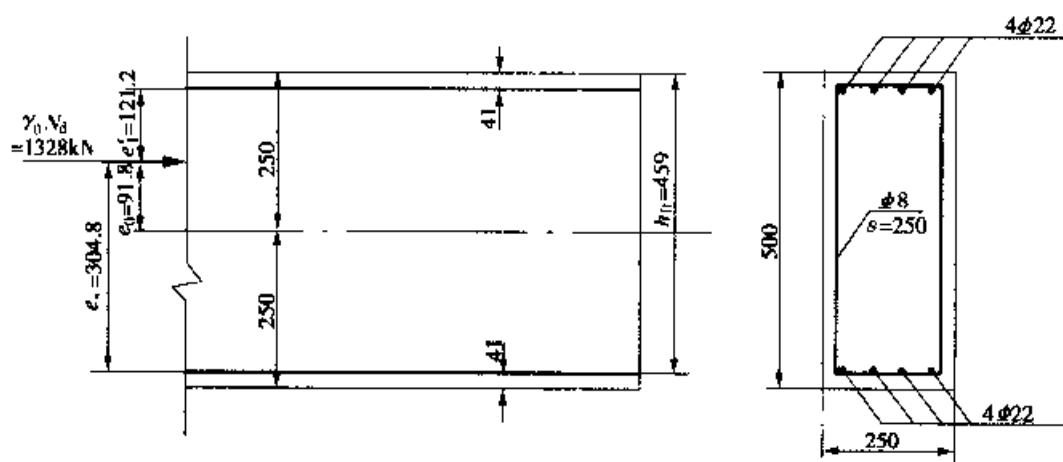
偏心受压构件计算简图及配筋 (尺寸单位: mm)
